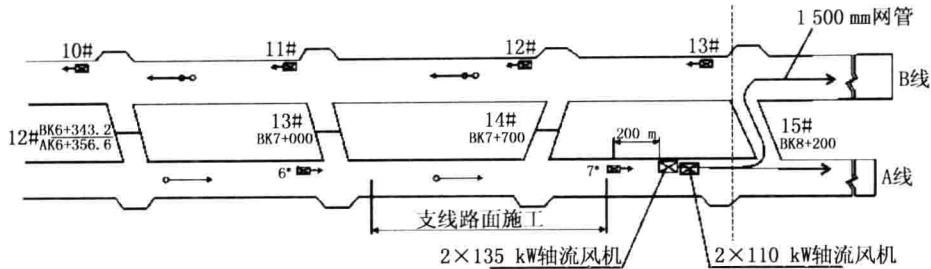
锦屏水电站辅助洞风机平面布置示意图
